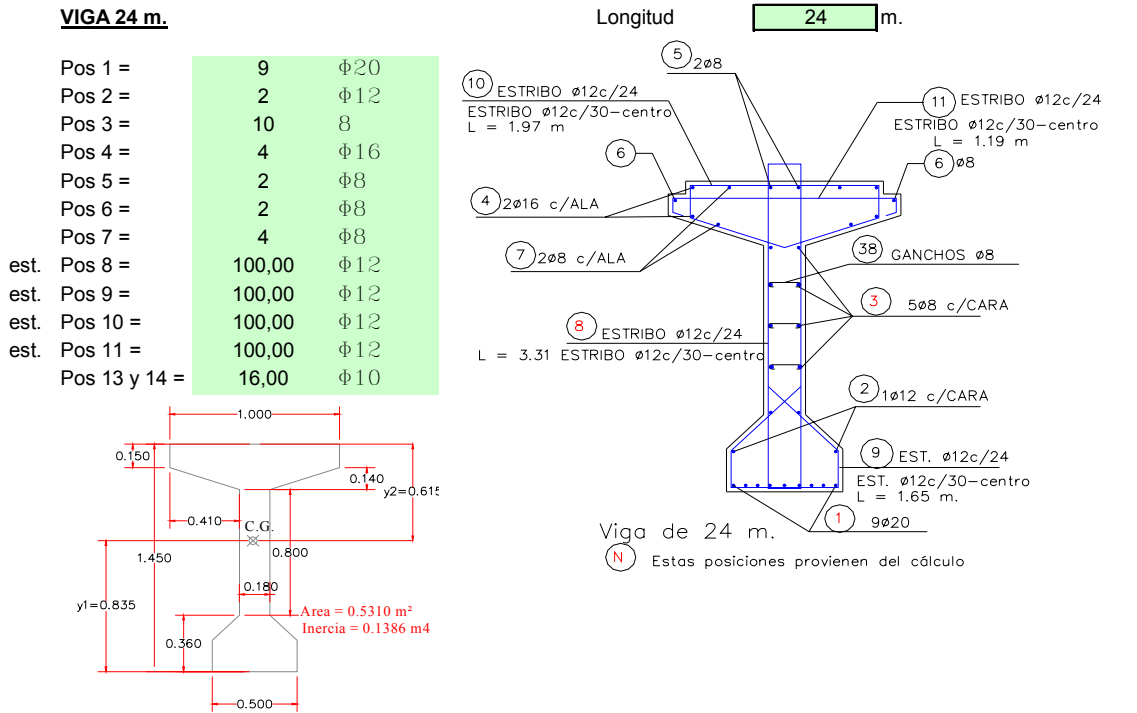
CUANTÍAS DE ARMADURAS PASIVAS EN VIGA DE 24 m.
